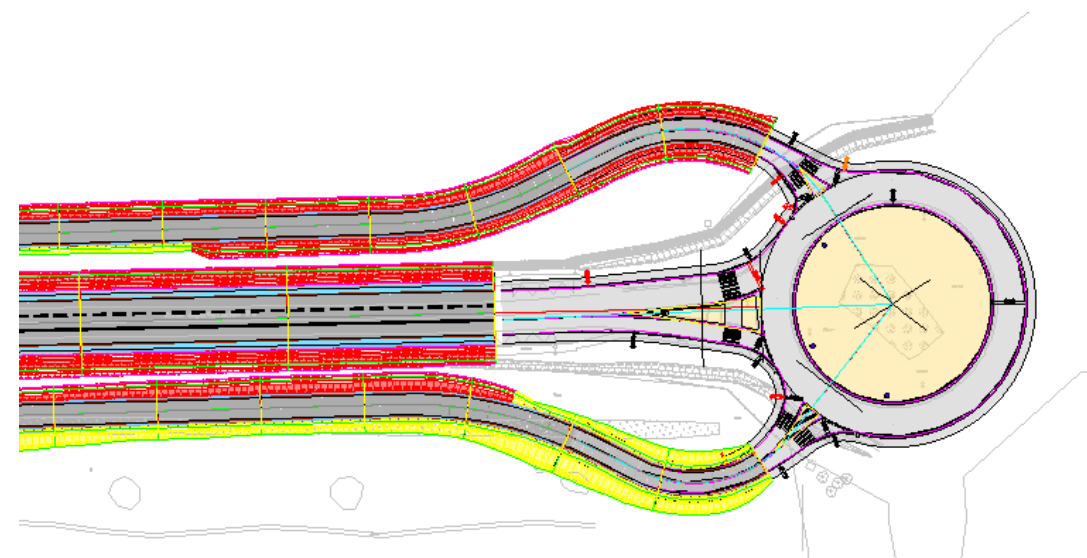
plan de détail de la sortie du giratoire des Fontenelles à 2 voies
